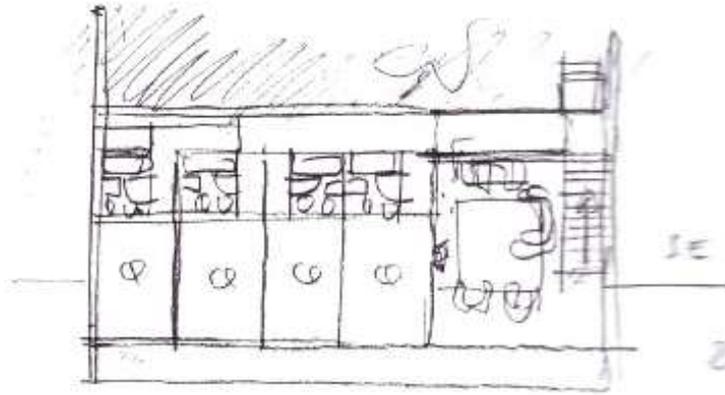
Plan Dessin de Souto de Moura⁴⁴⁵
